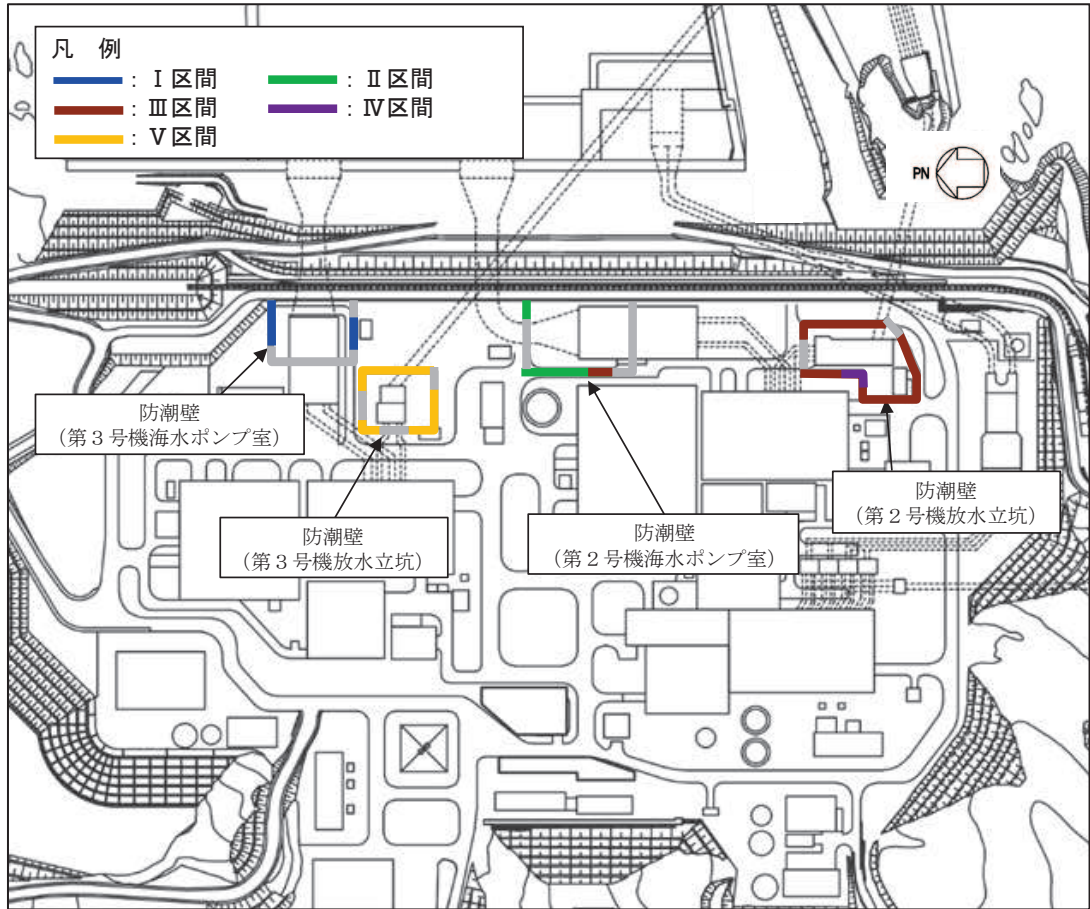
鋼製遮水壁（鋼板）の区間配置図
